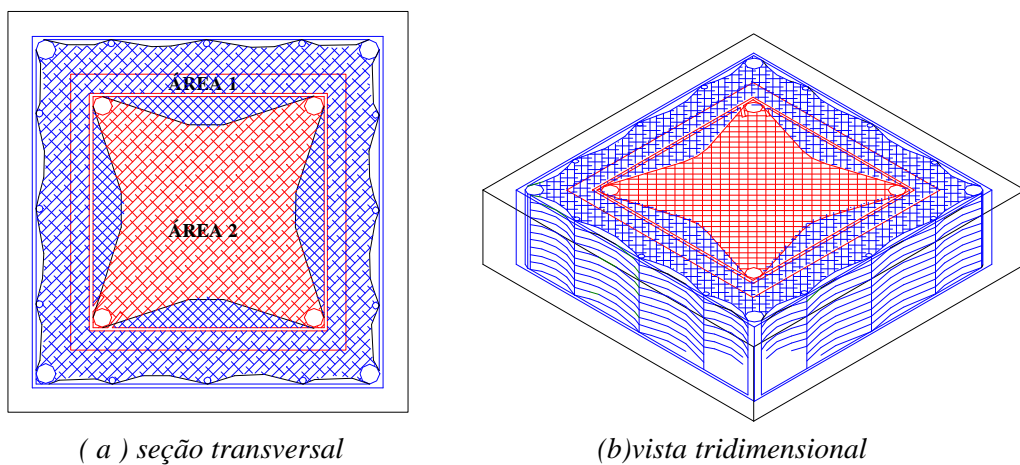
Áreas de confinamento adotadas para o pilar reforçado
